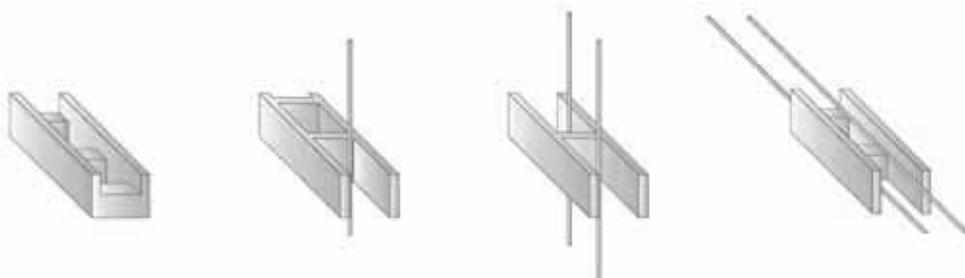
Recorte de tabiquillos para disponer la armadura en piezas estándar.
